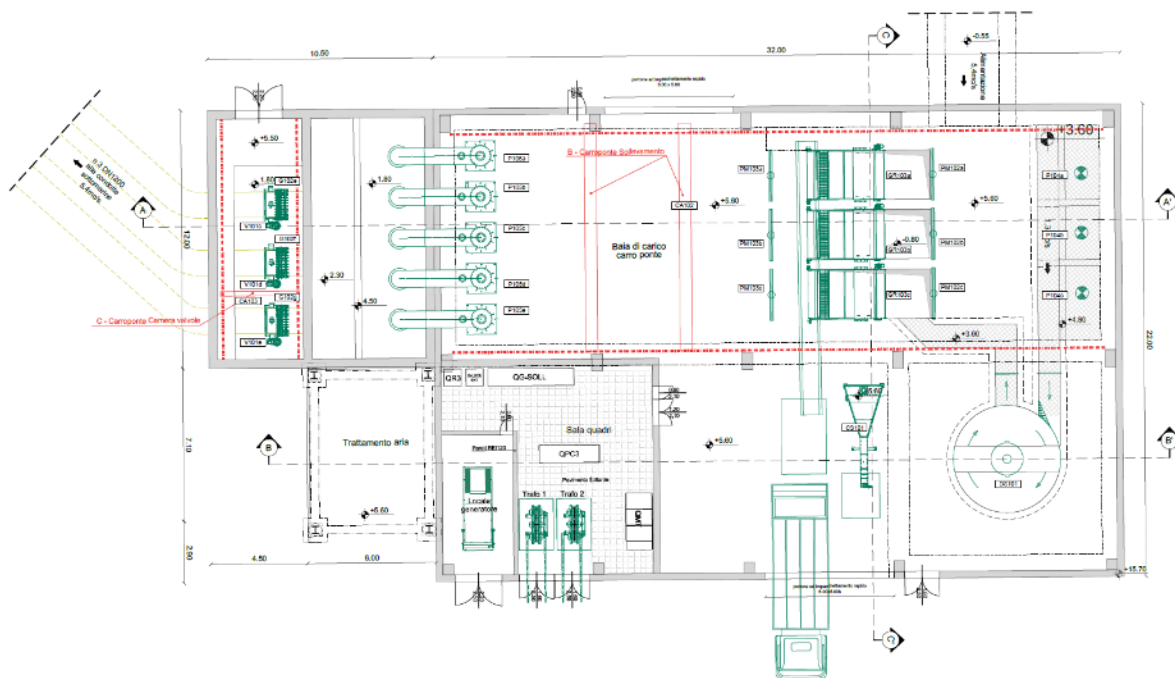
Nuovo impianto di sollevamento a mare e pretrattamento – Planimetria
